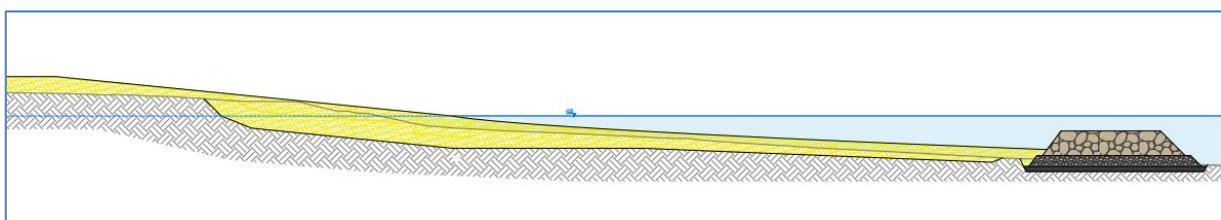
Realizzazione del ripascimento: sezione trasversale tipologica di progetto
